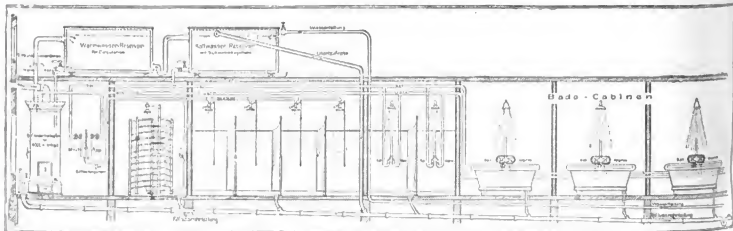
Badeanstalt. Z. A. Bade- und Warmwasserbereitungs-Anlagen.
